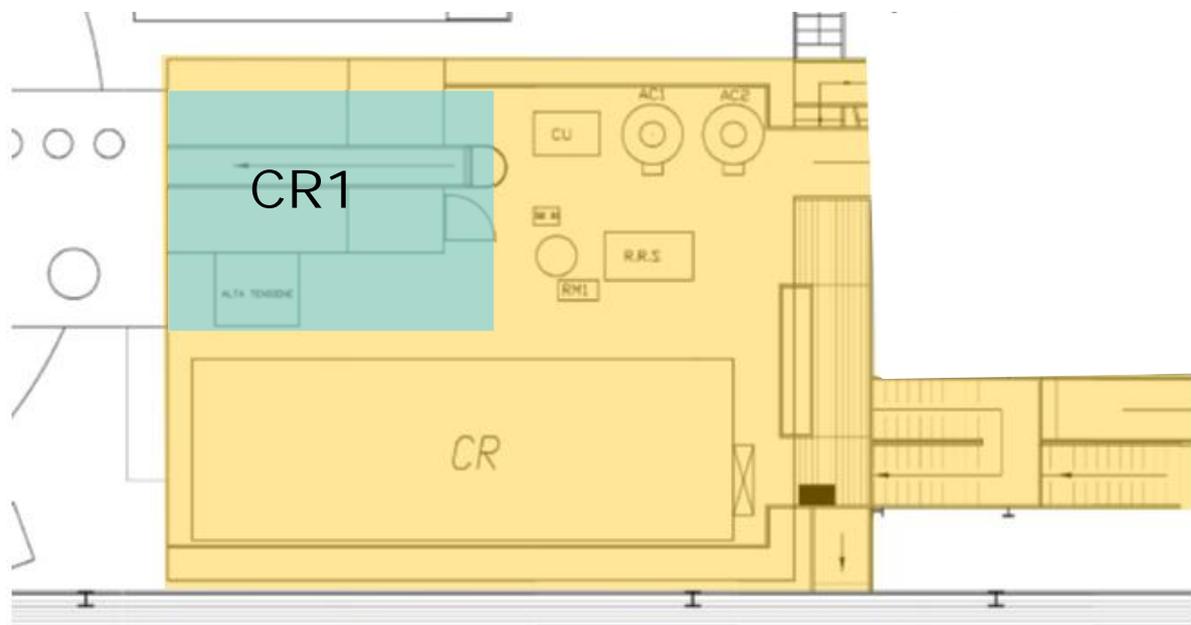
Big Building West (LNGS-C-BBW) e CR1
